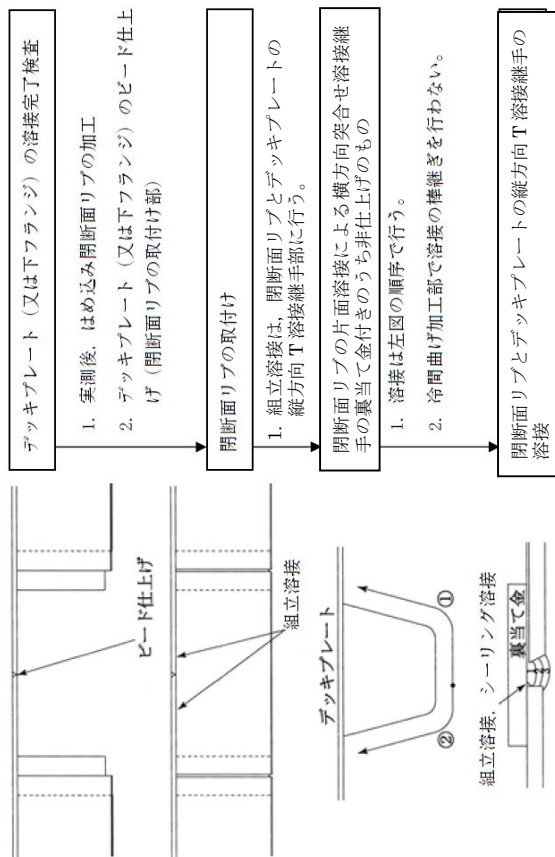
閉断面リブの現場溶接施工要領例
